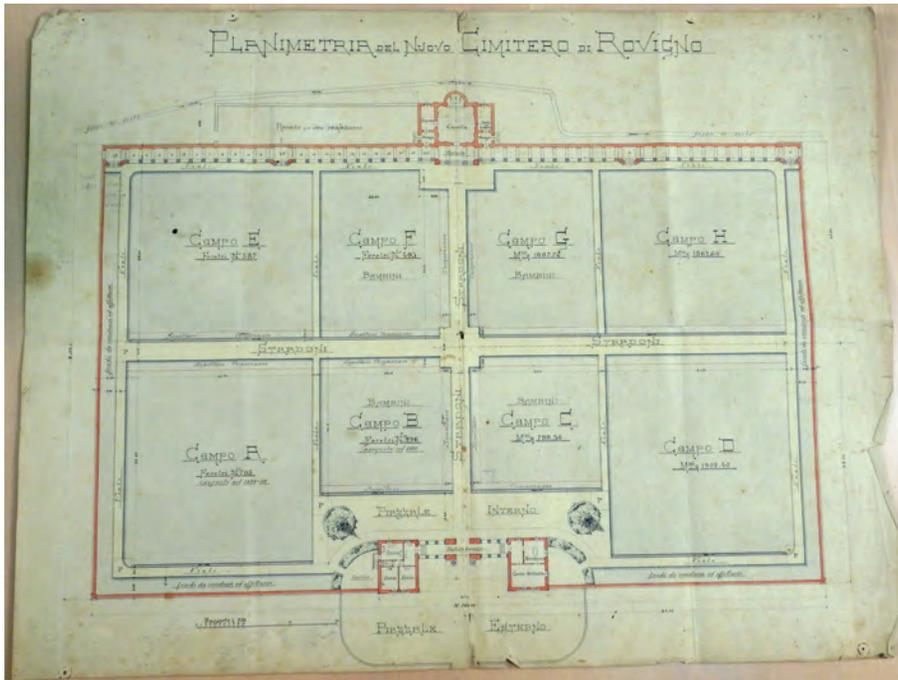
Planimetria definitiva del cimitero *Alle Laste* (Museo Civico – Rovigno).
